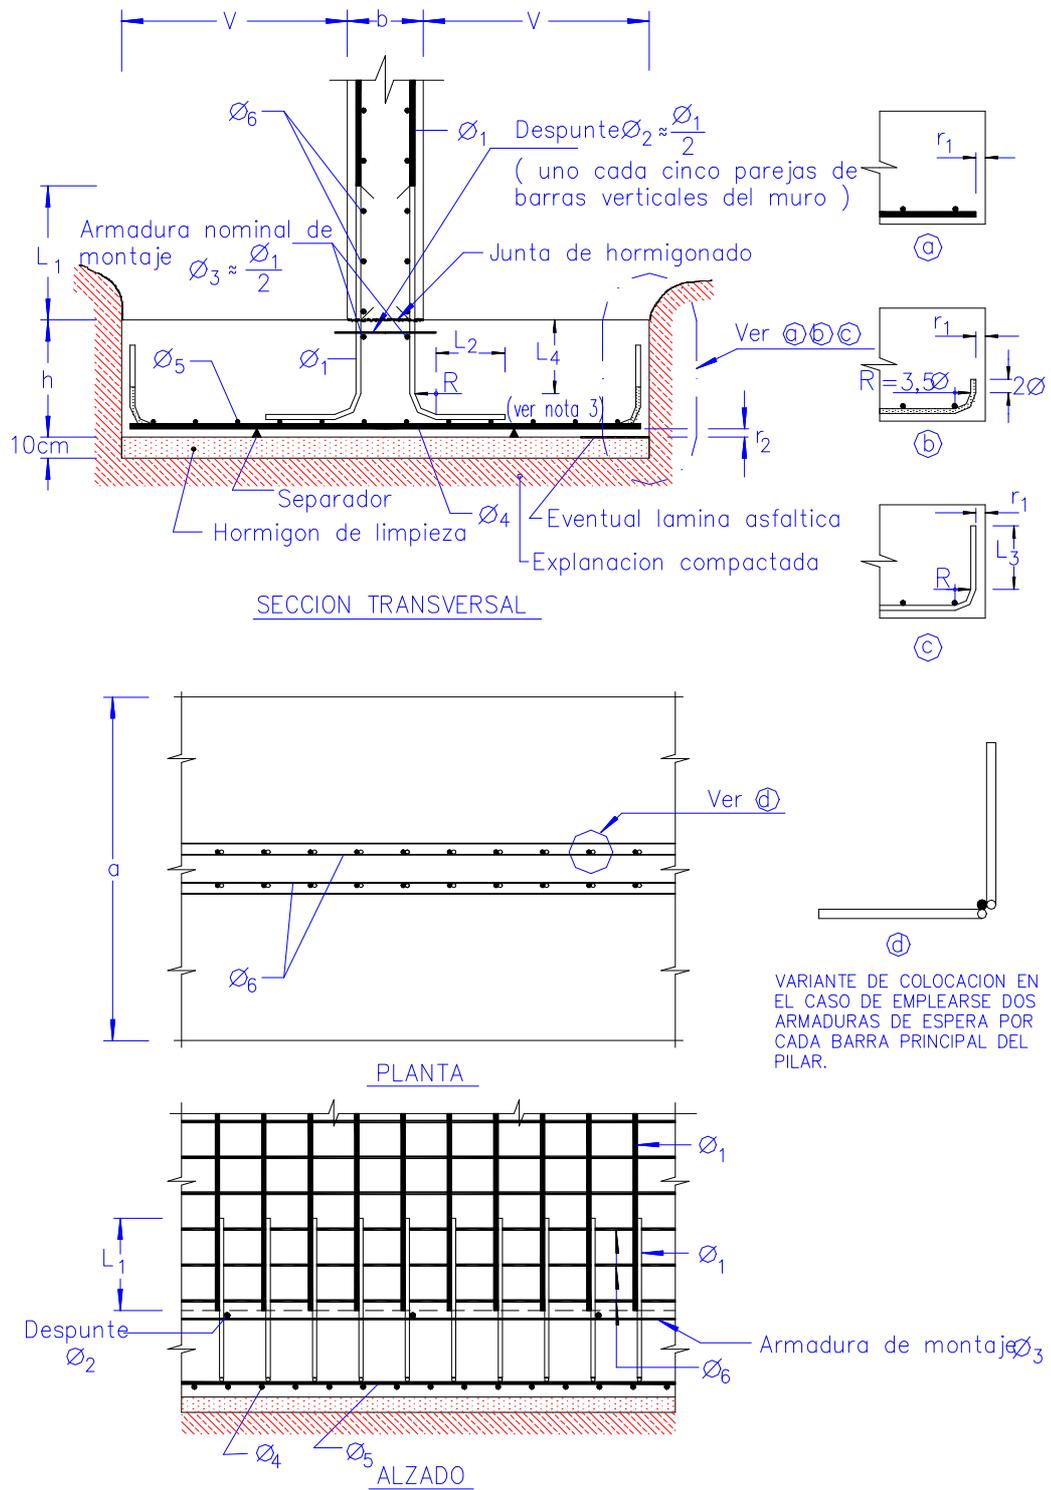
Zapata corrida soportando un muro de hormigón armado
